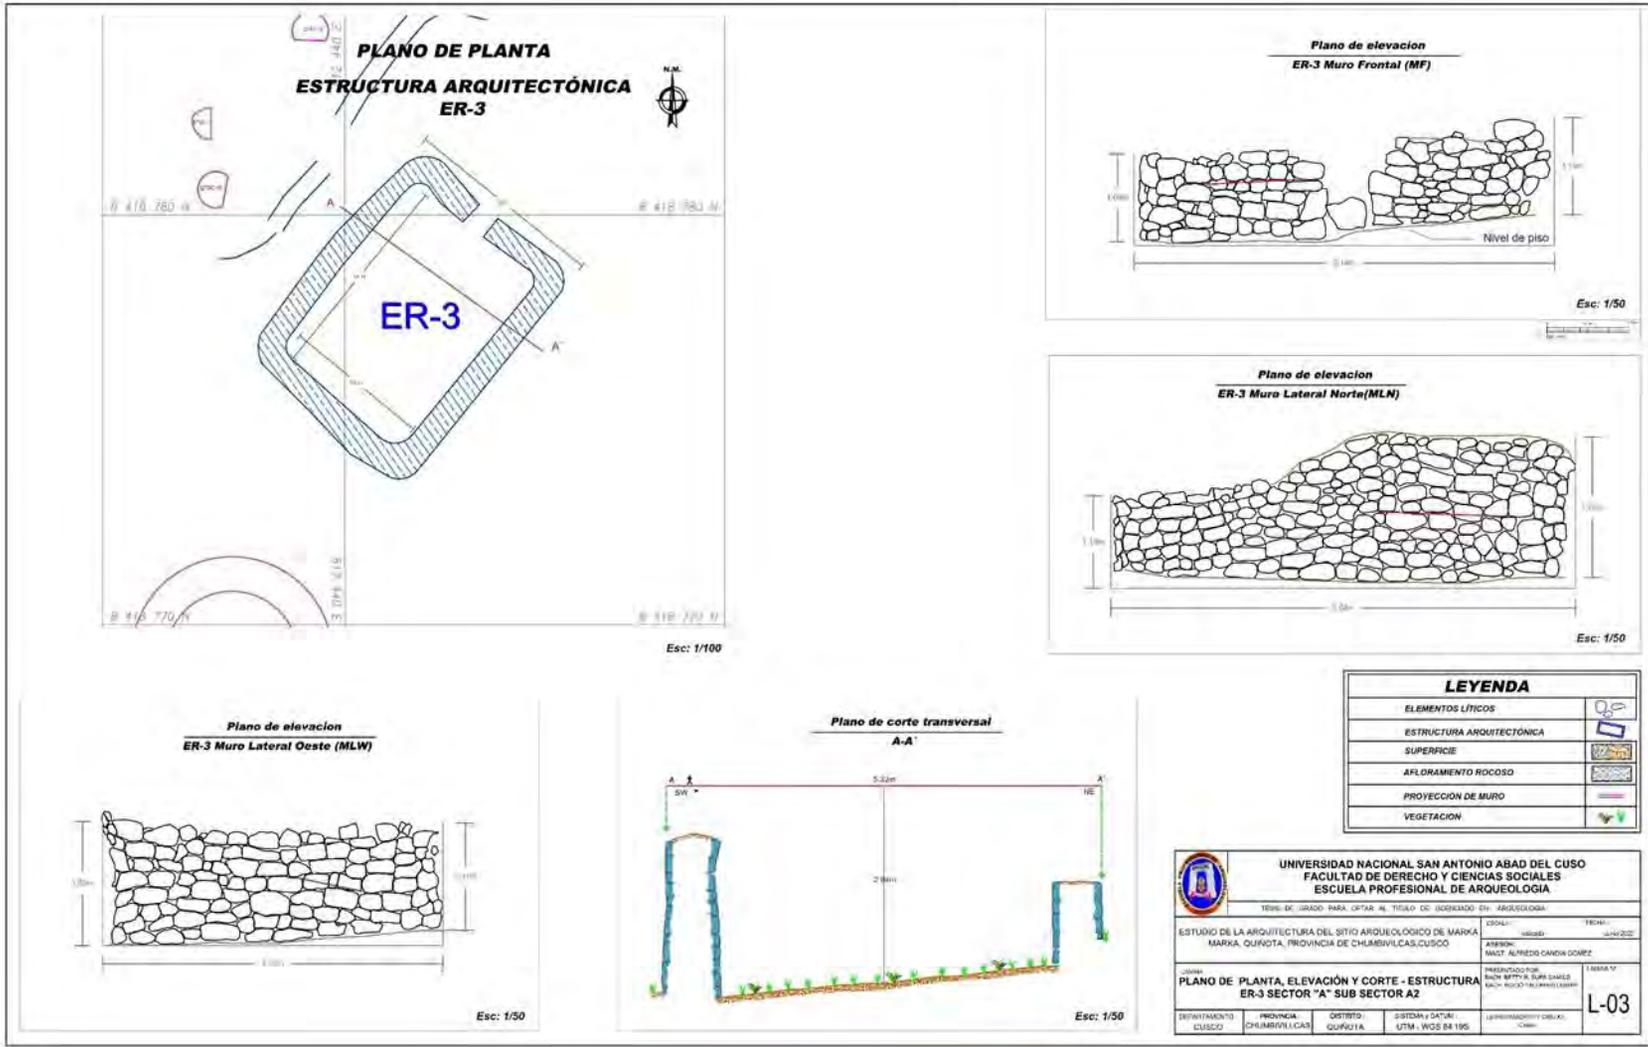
Plano de Planta Estructura Arquitectónica ER-3.
